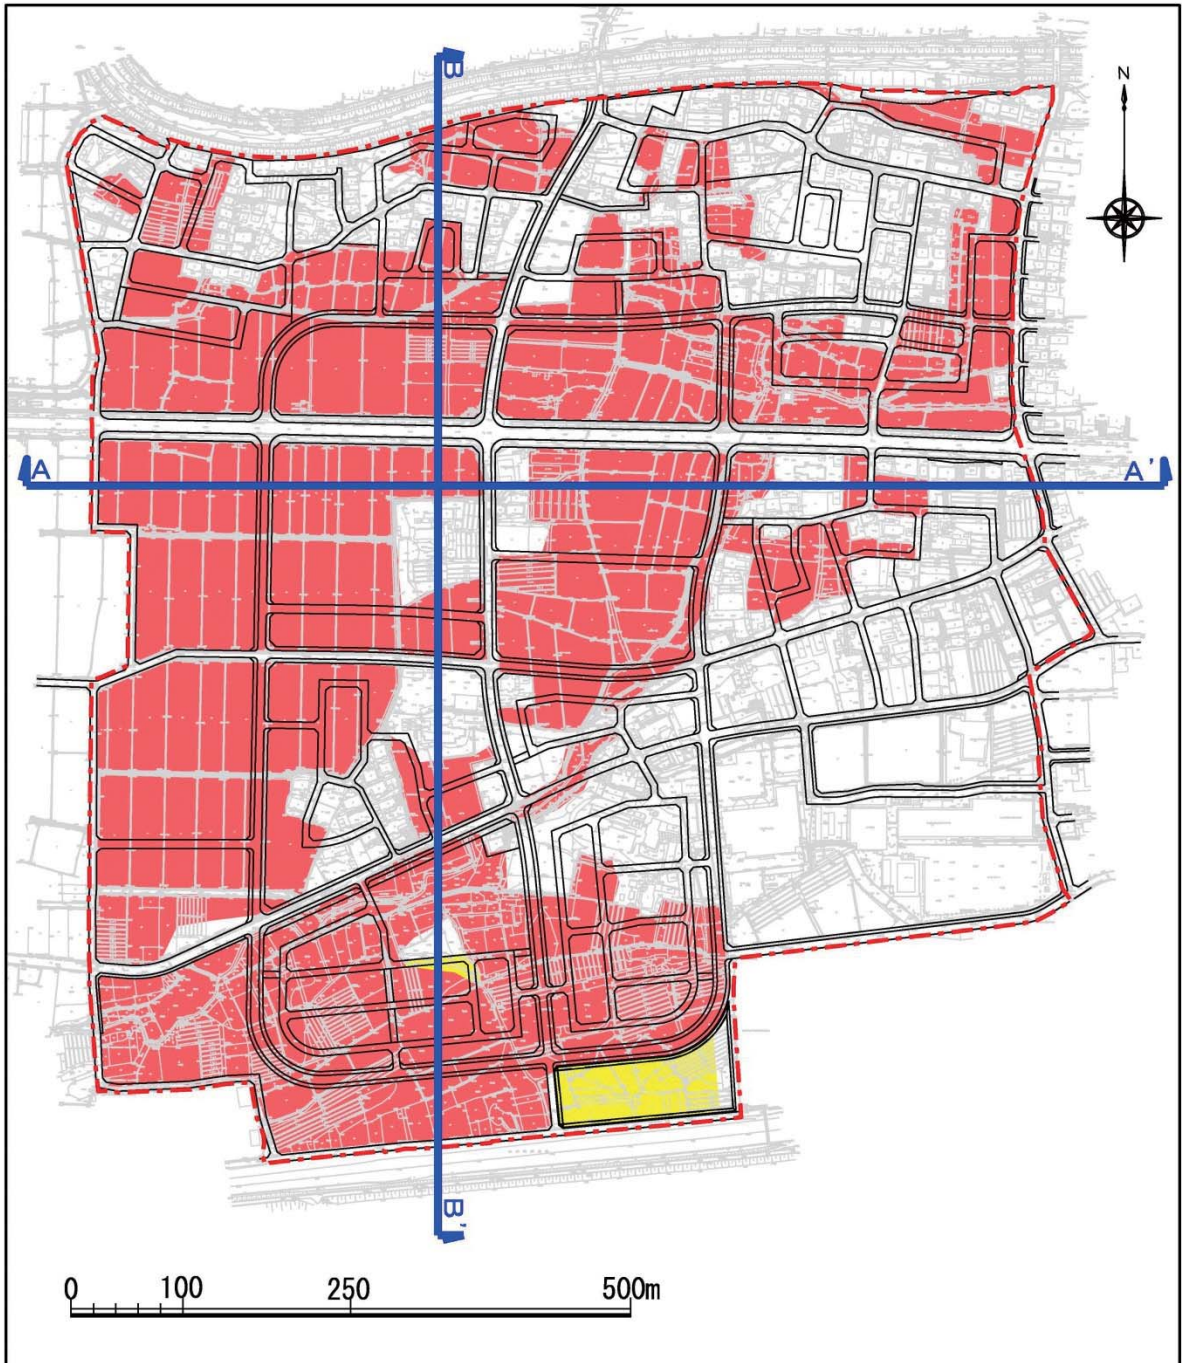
(1) 造成計画平面図 (変更前: 評価書)
